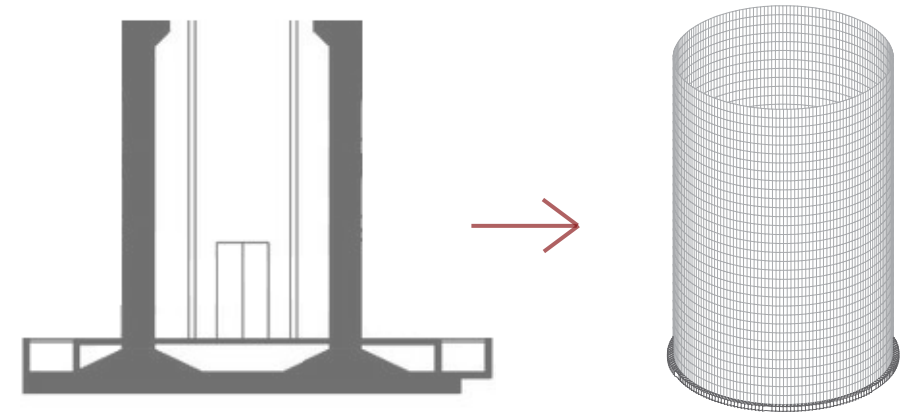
Modelización del cilindro central y la cimentación en elementos finitos
